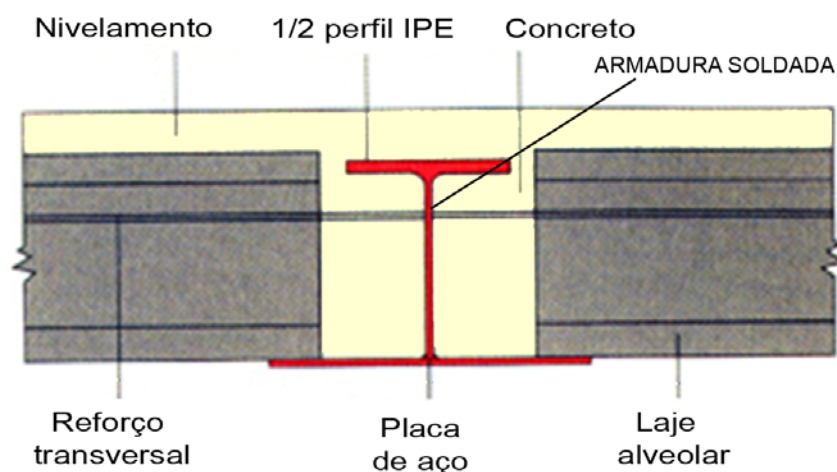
Detalhe construtivo das lajes alveolares apoiadas em viga metálica (Fonte: ArcelorMittal)
